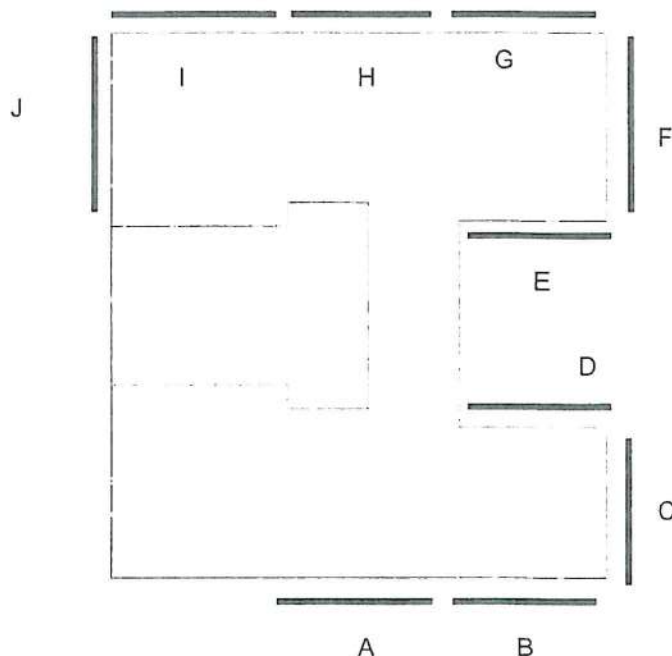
Dislocazione planimetrica delle prove dinamiche.
